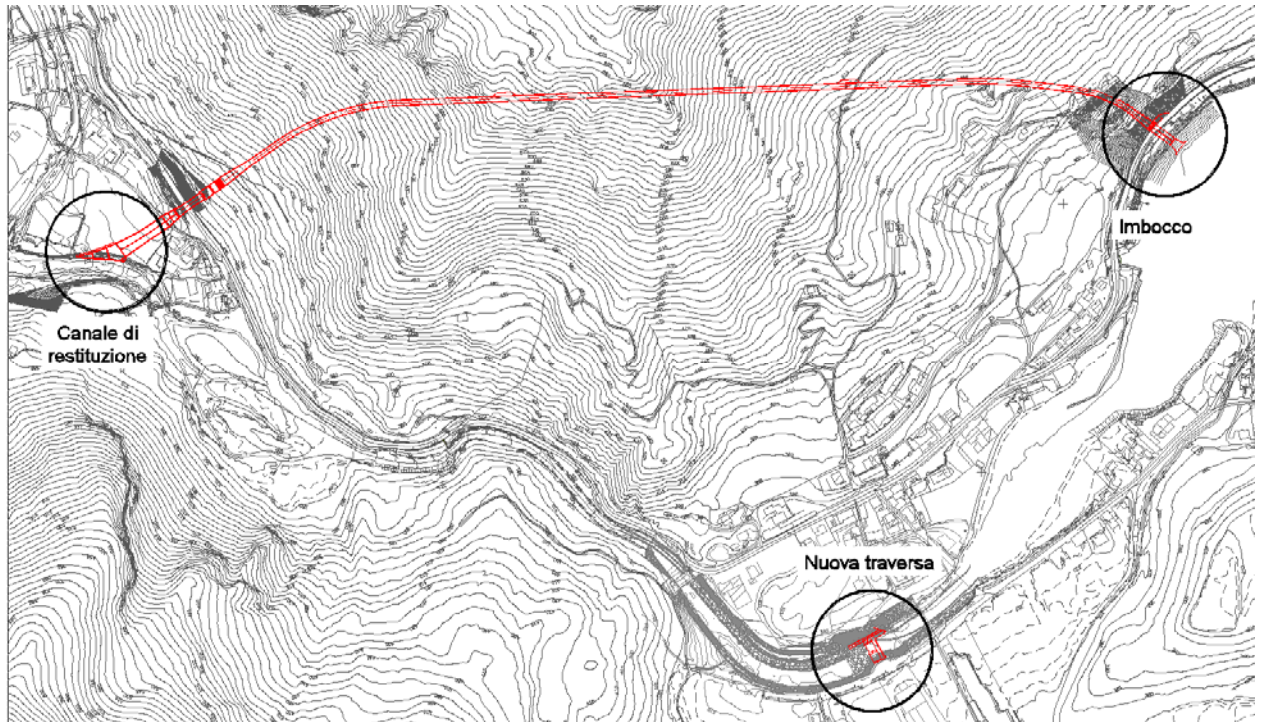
stralcio planimetrico con indicate le zone di intervento.
